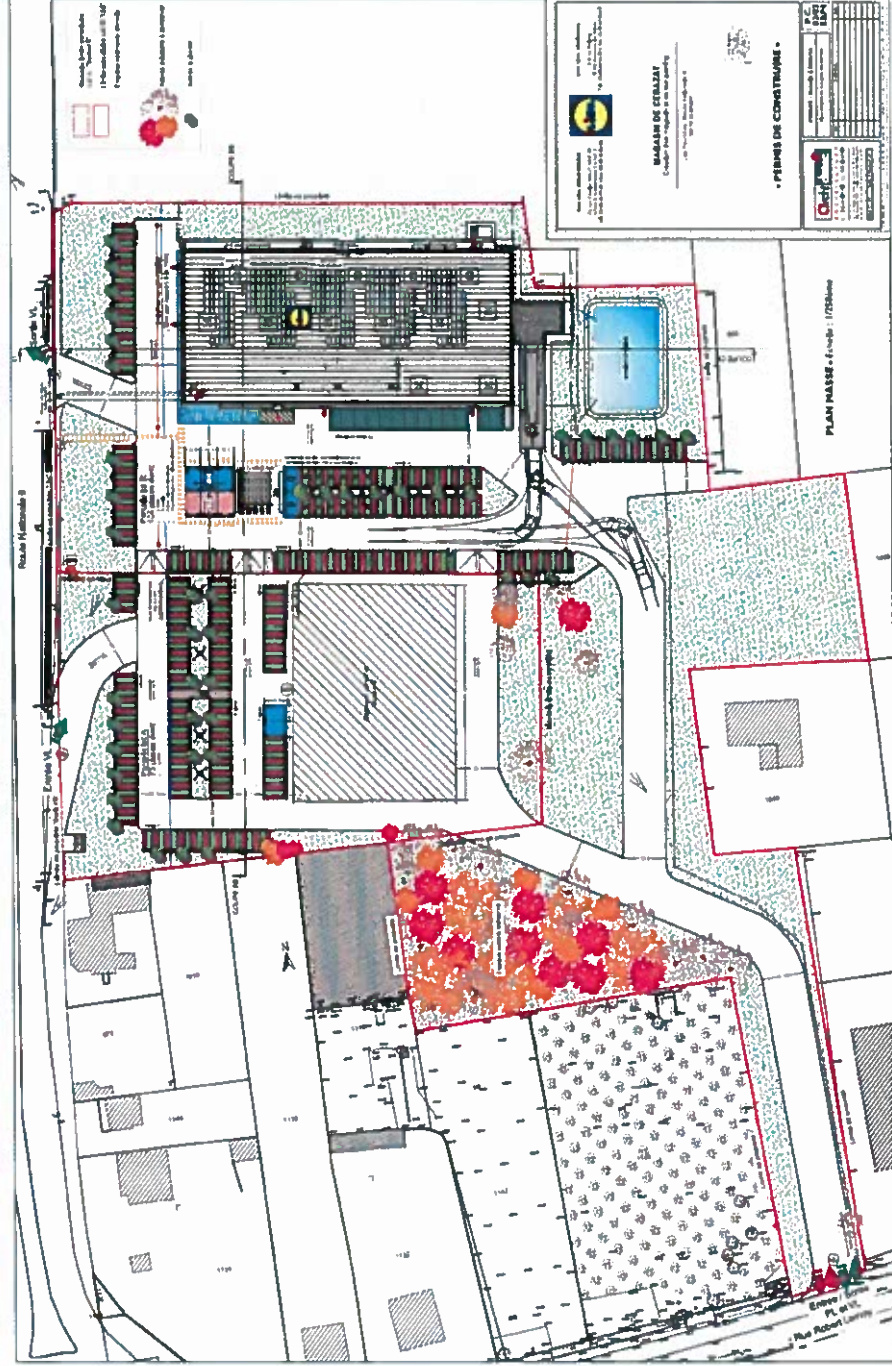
Plan masse du projet (Source : Cabinet d'Architecte Archidistec)
